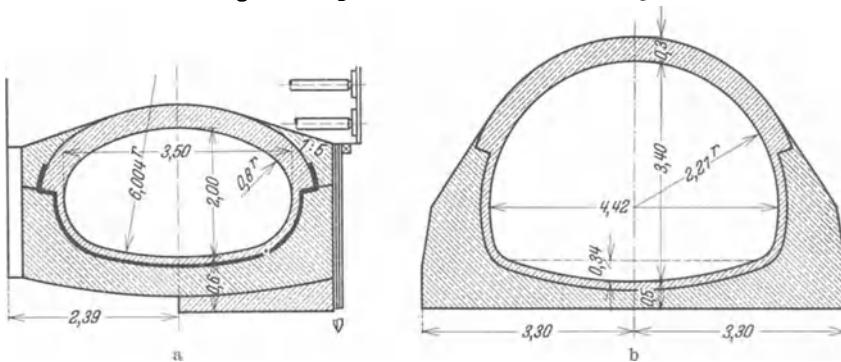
und b. Profile aus Beton und Klinkermauerwerk (nach Hahn und Langbein).
